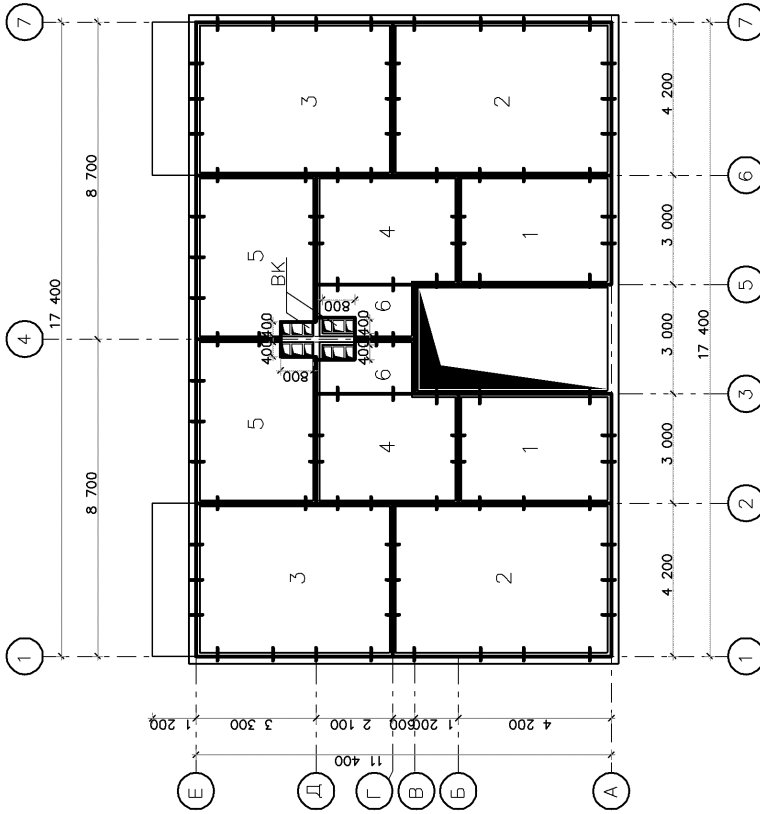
Пример оформления плана плит перекрытия размером на “комнату”
